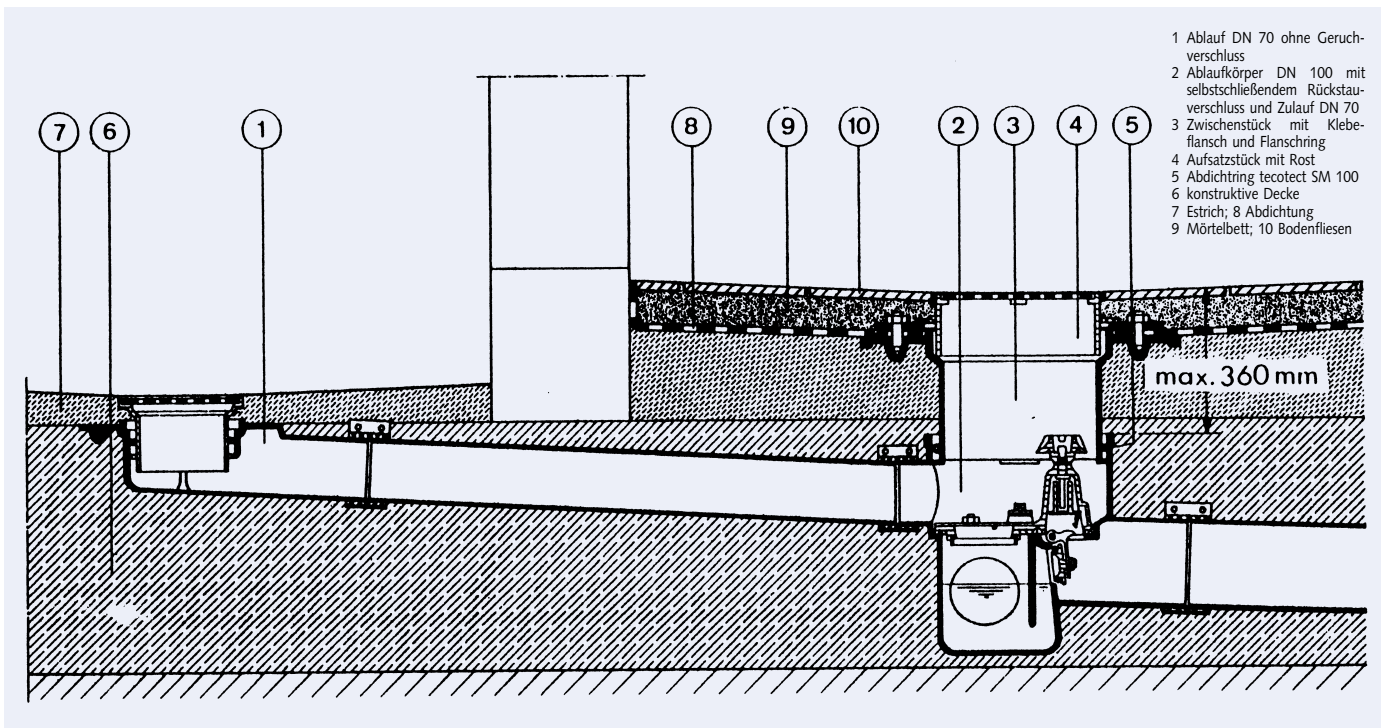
Einbauvorschlag für Ablauf DN 100 mit Rückstauverschluss und Zulauf DN 70 für Anschluss eines Abfalls ohne Geruchverschluss im frostgefährdeten Bereich
